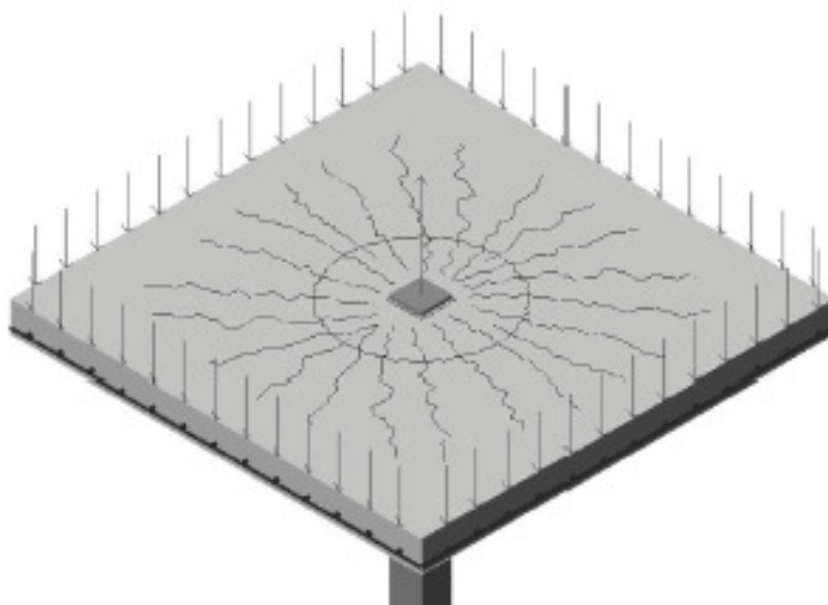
Configuração de punção de lajes. Panorama da fissuração
